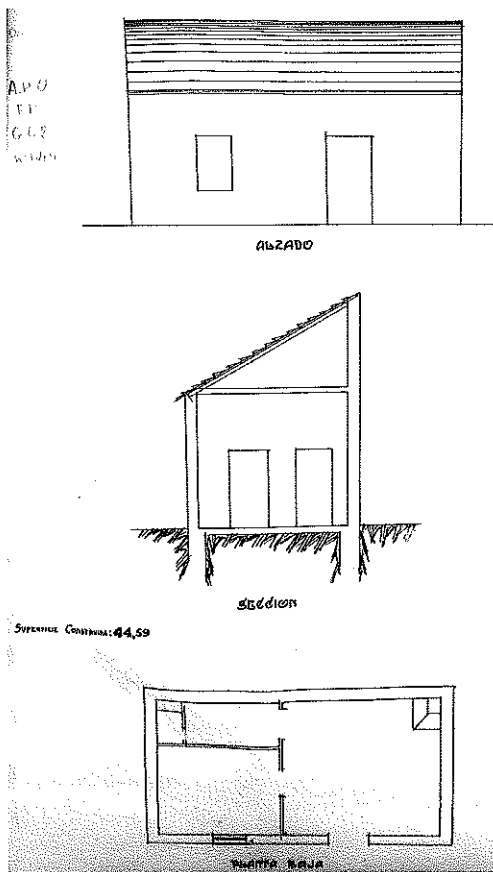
Alzado, sección y planta de la casa de D. Tomás Jinés Sáez, en Calle Ros, nº 2. Proyecto de Plan de Ensanche General de Orihuela. 1926 (A.M.O. G-68, nº 10/4).
